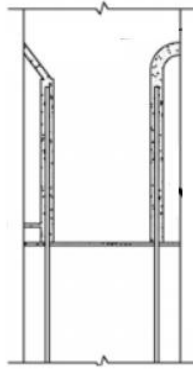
Ligação pilar-pilar. Adaptado: Fib (2014).
